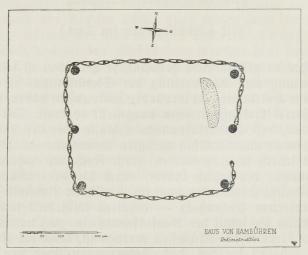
Saus von Sambühren. Rekonstruierter Grundrig.
